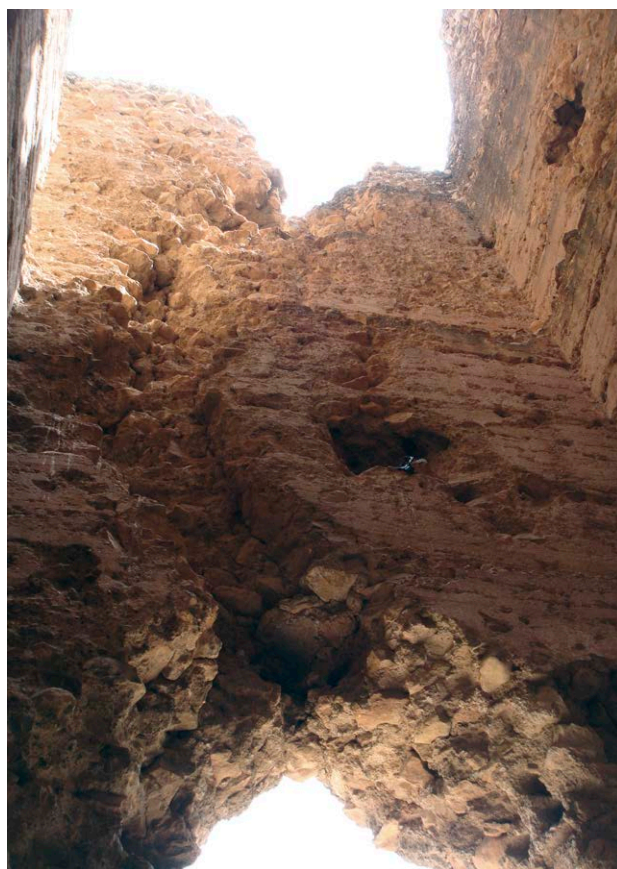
Fachada septentrional interna. Estado previo a la restauración
